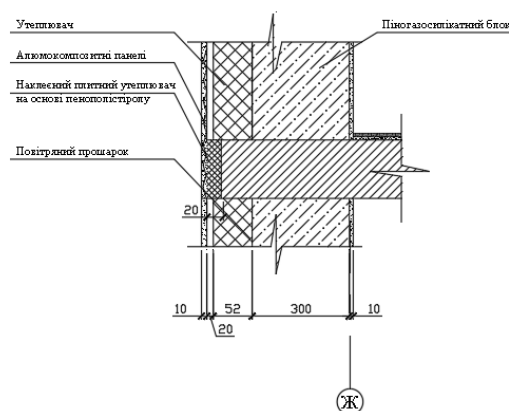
Розрахункова схема типової зовнішньої стіни з вентильованим фасадом
